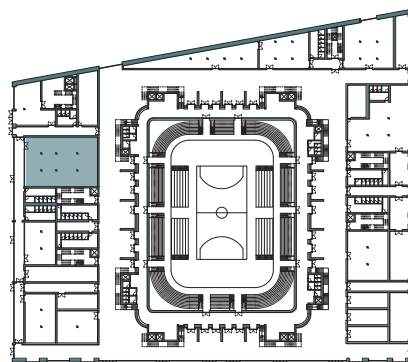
Pianta piano terra e individuazione uffici caso studio
